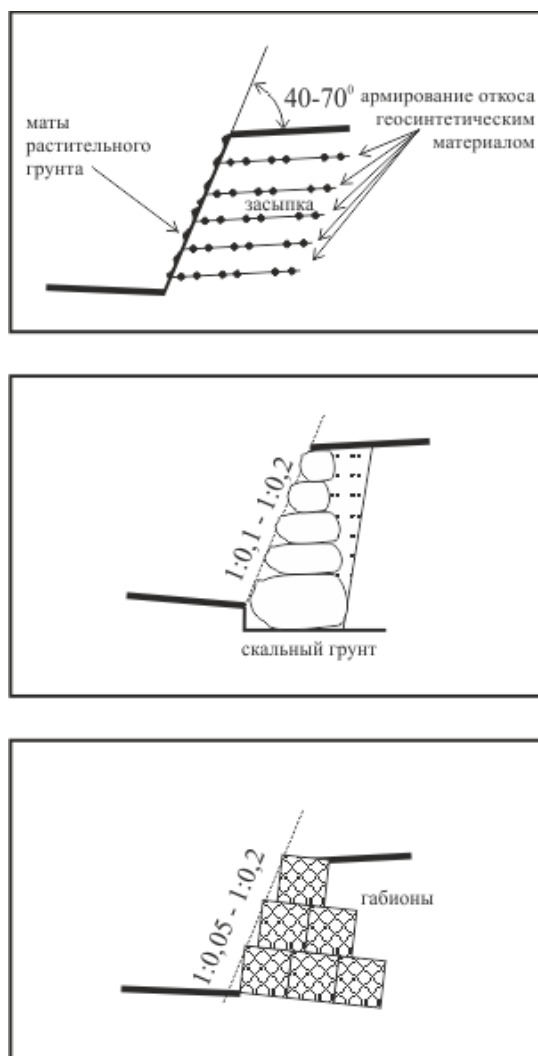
Повышение устойчивости откосов шумозащитной выемки: армированный грунт, каменная кладка, габионы
